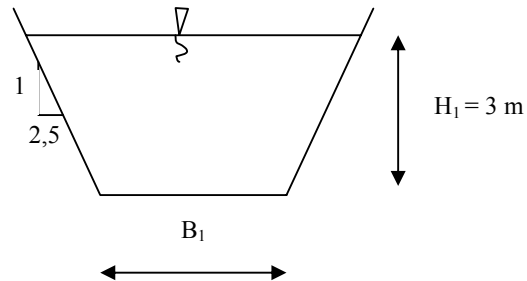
Bentuk potongan penampang melintang saluran rencana Ruas
